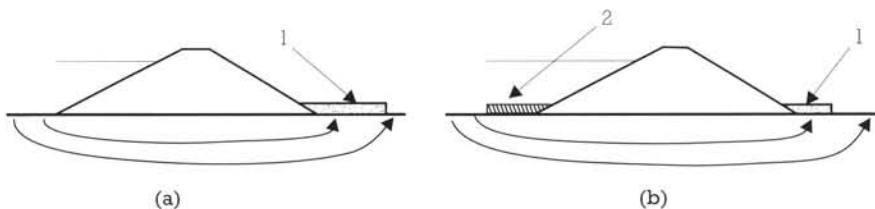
Schémas de principe du traitement d'une fondation par un filtre.
